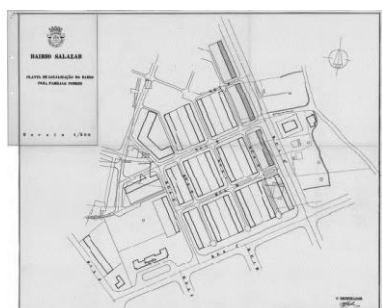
Planta do Bairro da Fundação Salazar, Tomar, s/d
